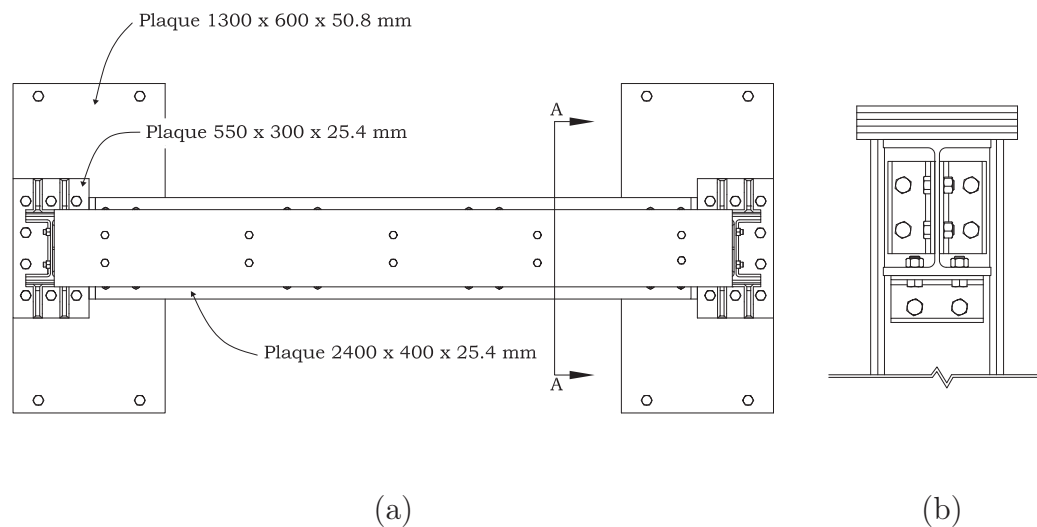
Montage expérimental (a) vue en plan (b) coupe A-A : assemblage poutre-colonne
